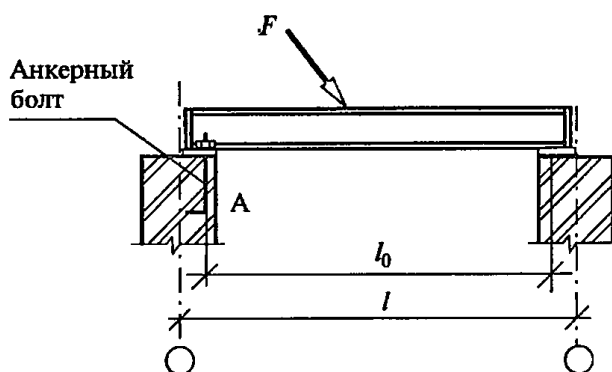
Крепление балки к опоре с помощью анкерного устройства
